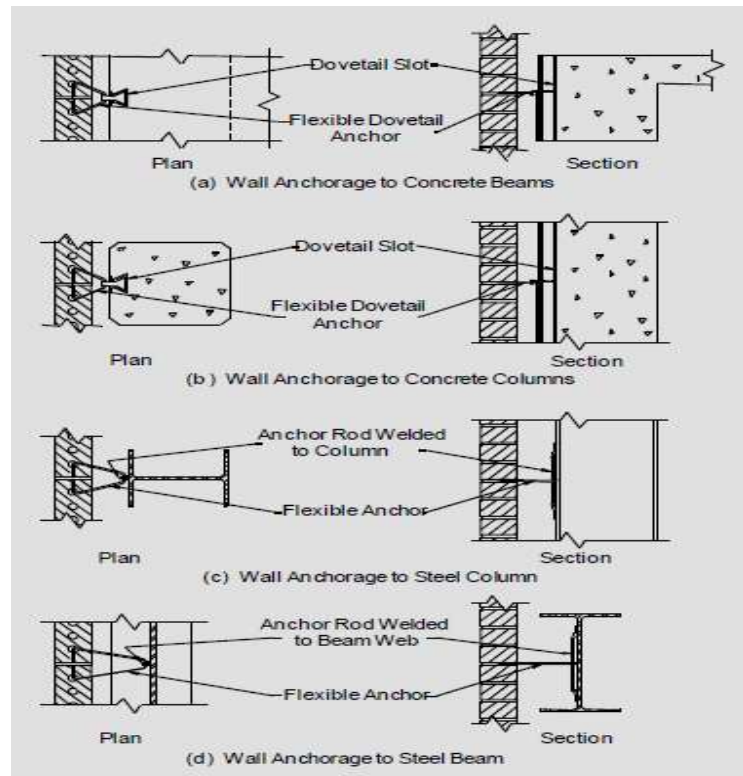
Conexión muro de albañilería con marco no estructurales (TMS 602-13 [8]).
